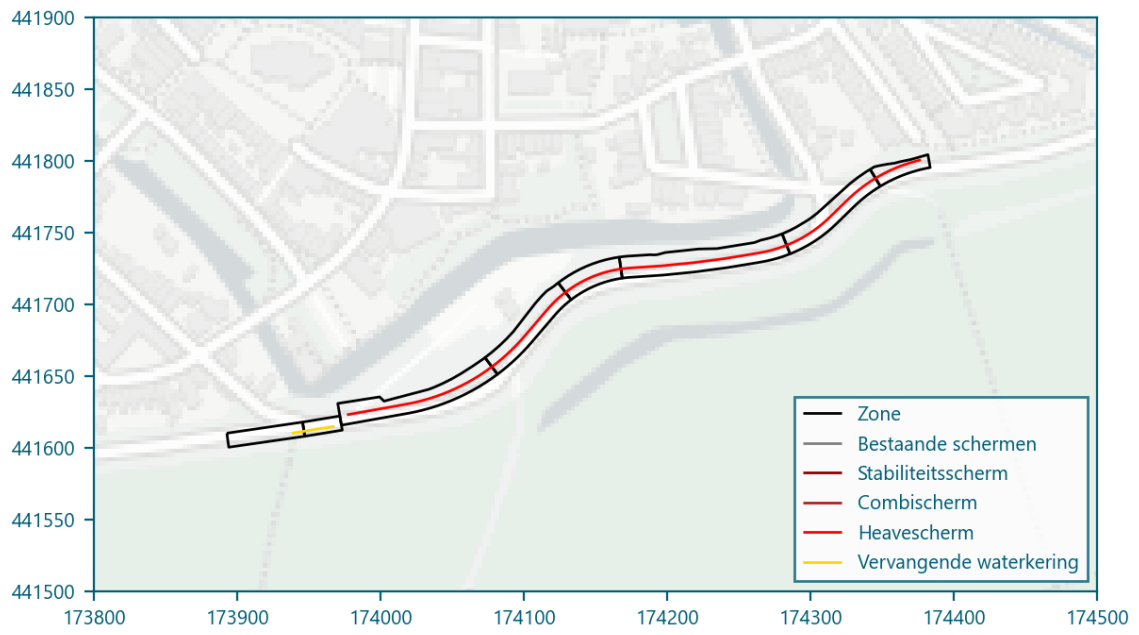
Overzicht zonering damwanden ontwerploop 2 te hoogte van het Hoorwerk
